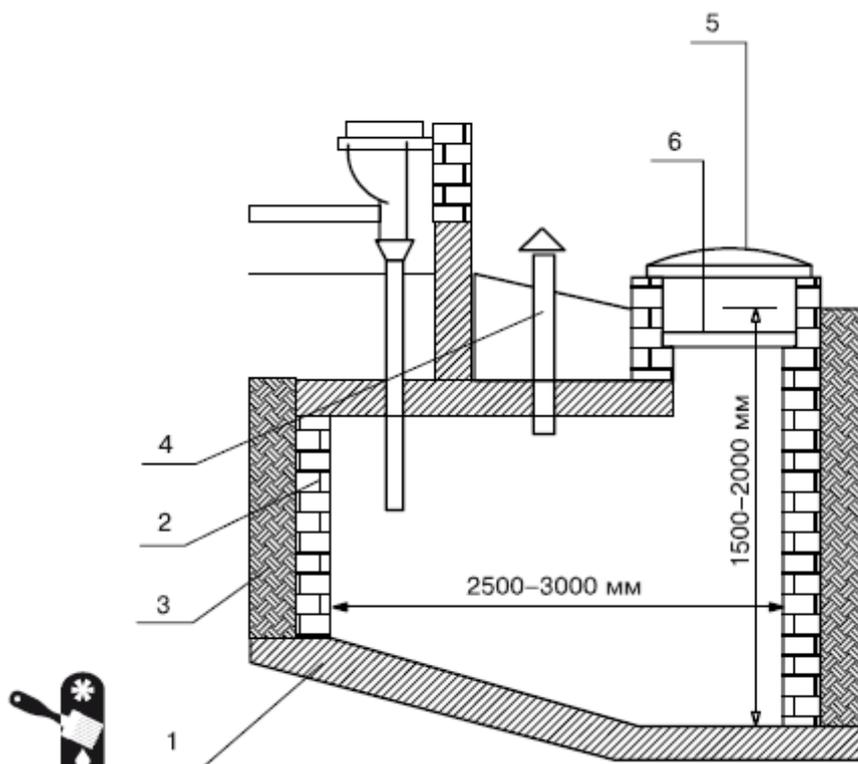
Устройство выгребной ямы: 1 – бетонное основание; 2 – кирпичные стены; 3 – глиняный замок; 4 – вытяжка; 5 – чугунная крышка; 6 – деревянная крышка
